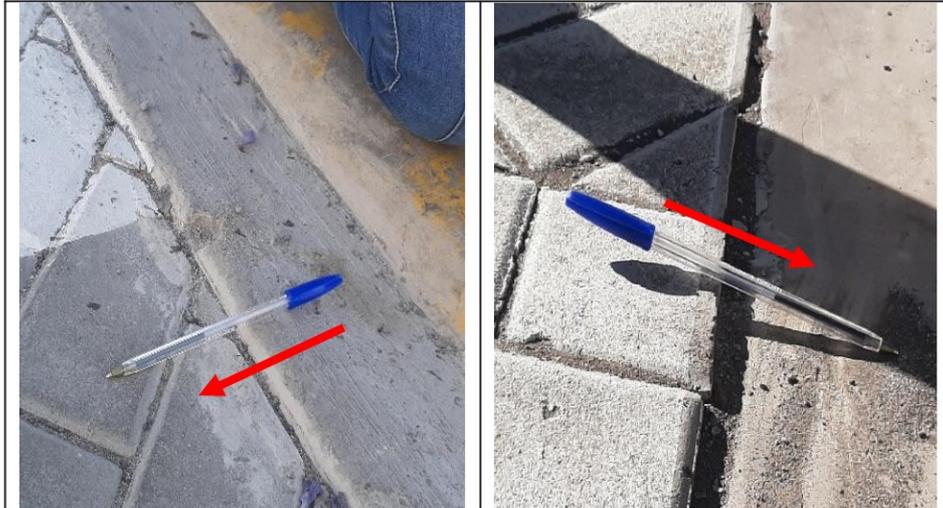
Desnivel sardinel sumergido con relación al pavimento adoquinado, avenida Ramón Castilla entre las calles 20 de abril y Gallegos.
